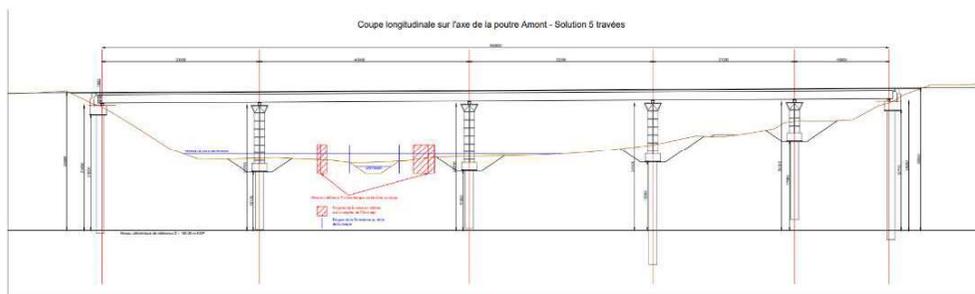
COUPE LONGITUDINALE SUR L'AXE DE LA POUTRE AMONT – SOLUTION A 5 TRAVEES (SOURCE : CEREMA)
